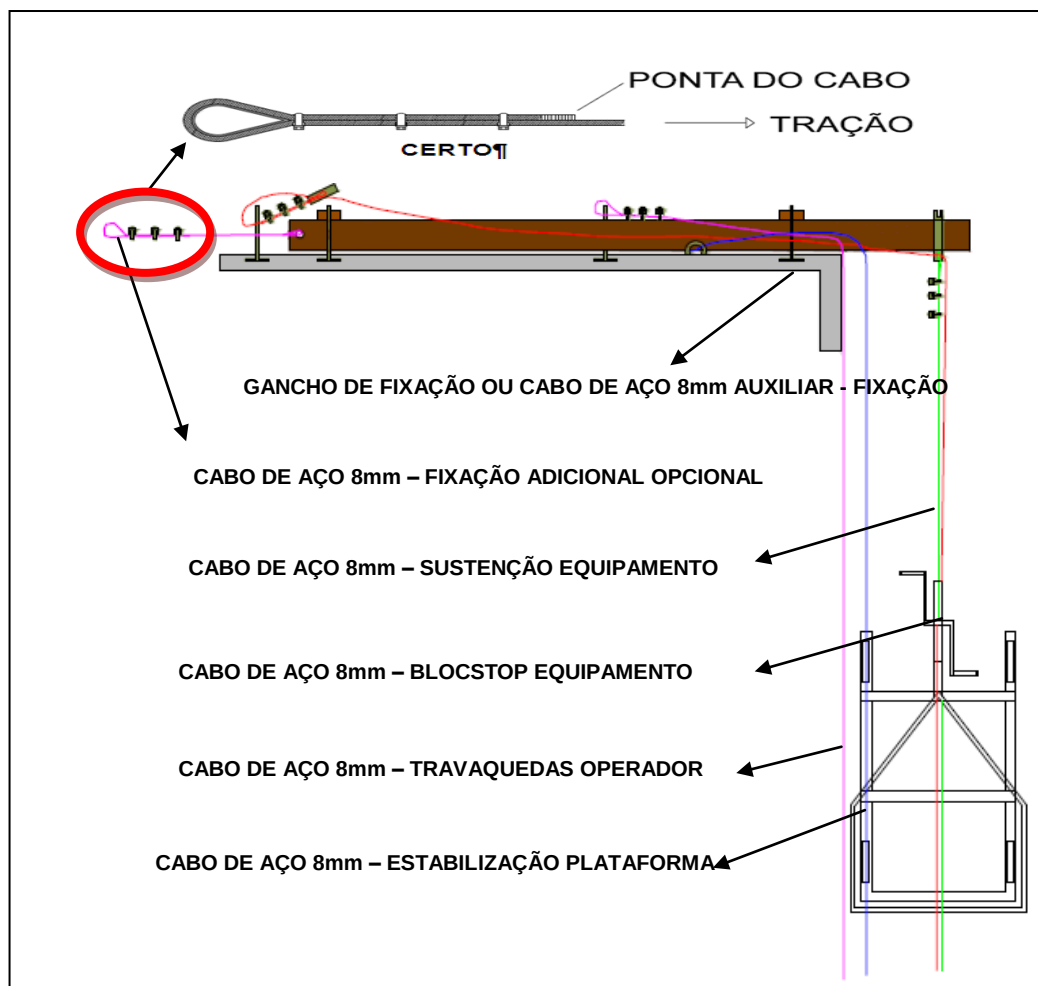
Fixação com perfil metálico apoiado diretamente na laje
